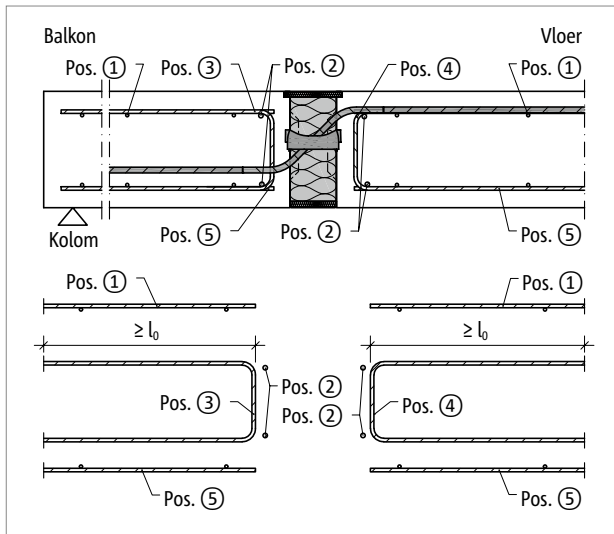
Schöck Isokorb® T type Q-E-VV: Bijlegwapening
